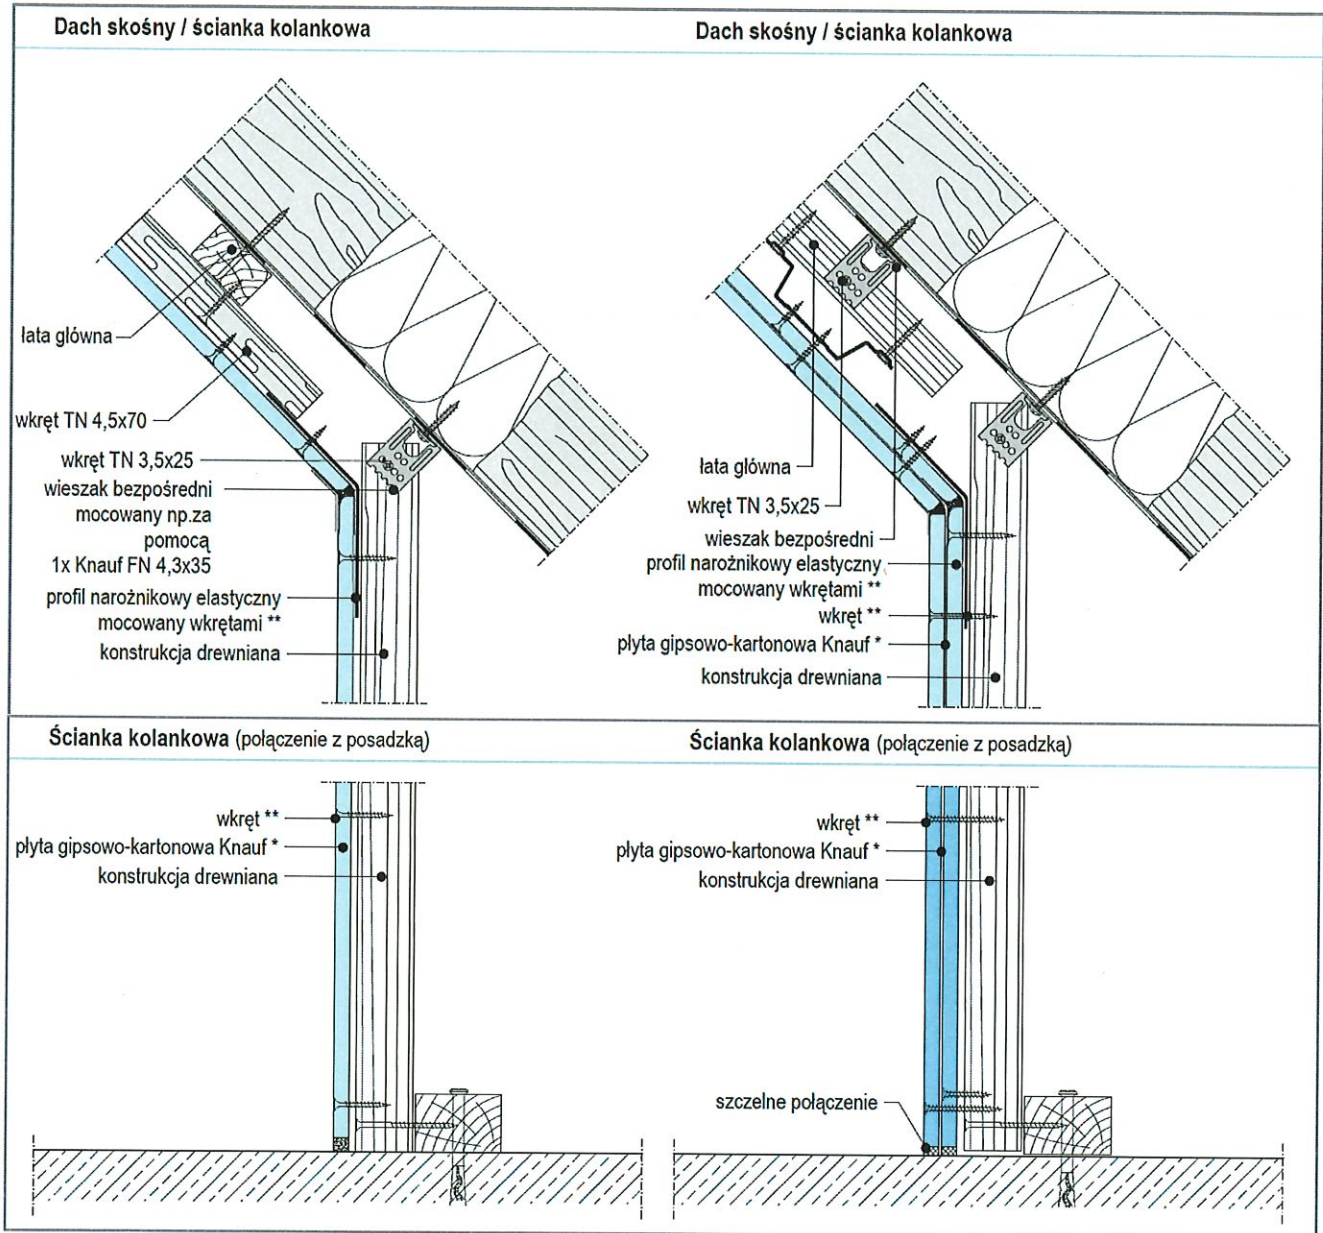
System D613.pl na konstrukcji pojedynczej z profilem sprężystym, przekrój pionowy dachu spadzistego.
